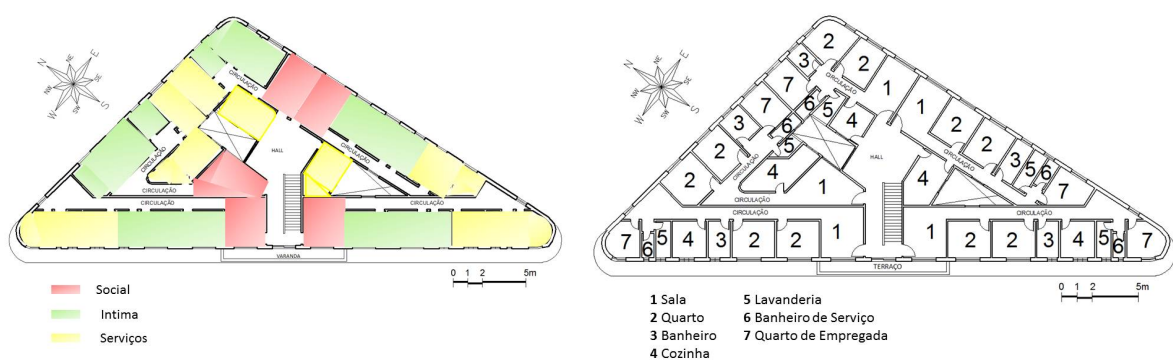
Planta Baixa do Pavimento Térreo e Planta de Localização dos apartamentos. Fonte: Autora, 2016.
